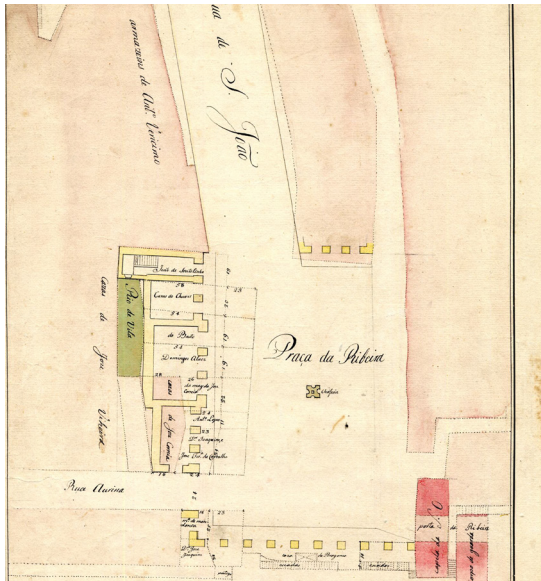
Planta para a construção de arcadas na Praça da Ribeira. Indica a localização do assento militar, do chafariz da Praça da Ribeira e de várias propriedades particulares.
